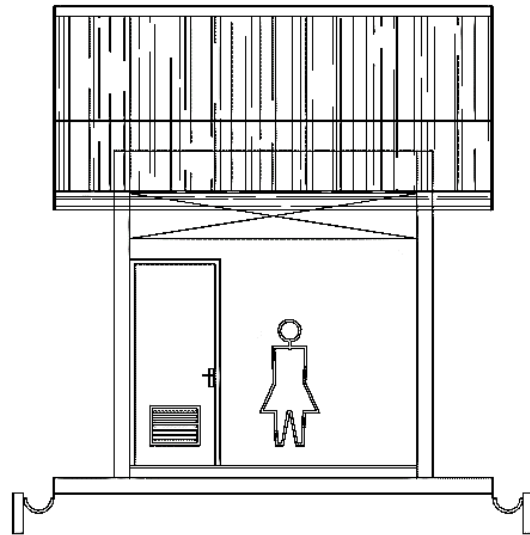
Contoh Denah Toilet Wanita 20,25 m²
